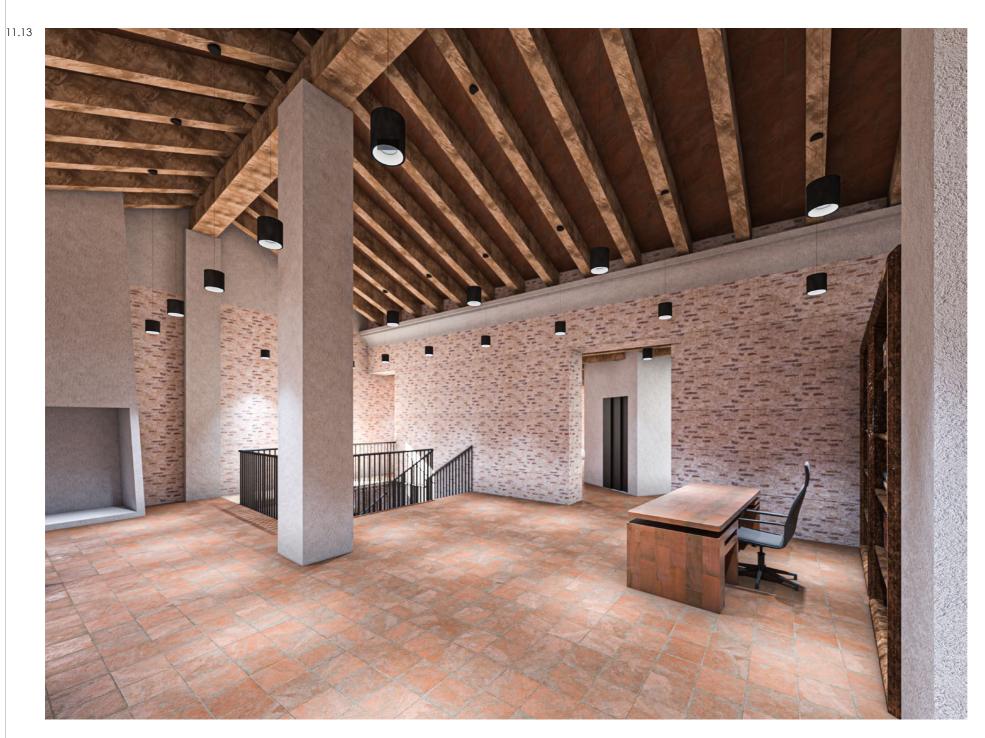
Vista del distribuidor de la biblioteca. Imagen (11.14) Vista de la biblioteca.
